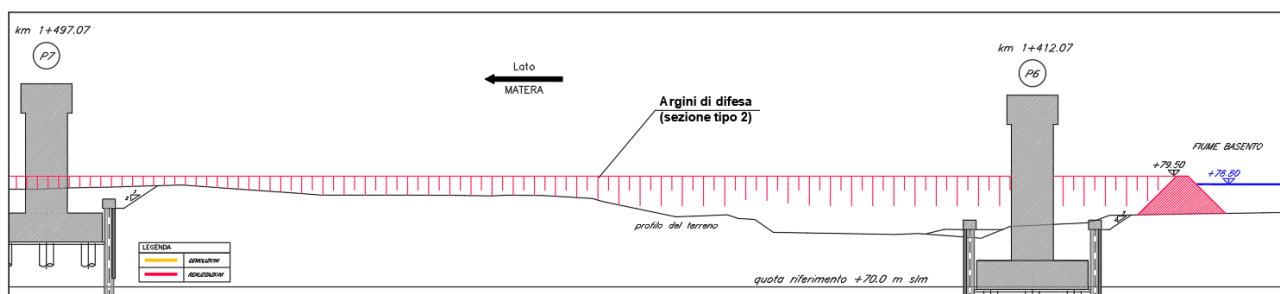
Livelli idrici nella fase di cantiere 1, in corrispondenza della sezione di attraversamento.
